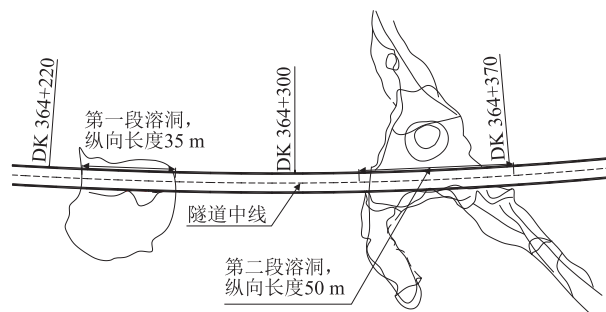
DK 364 + 220 ~ DK 364 + 370 地质平面示意图
